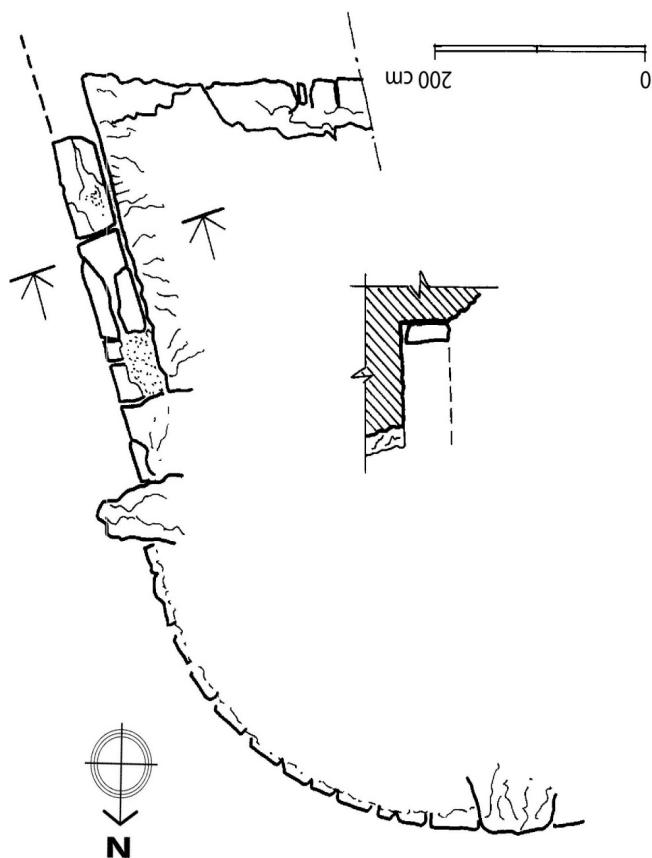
skicë planimetrike e murrit verior të kullës së Skënderbeut.
